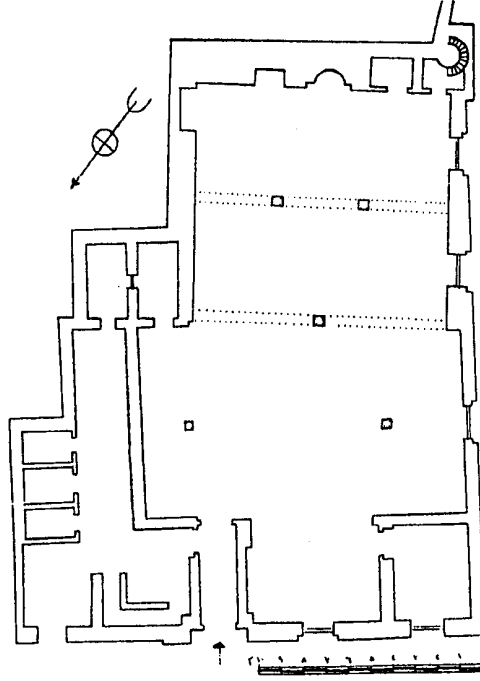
مسقط أفقي لجامع العريان بالقاهرة .
